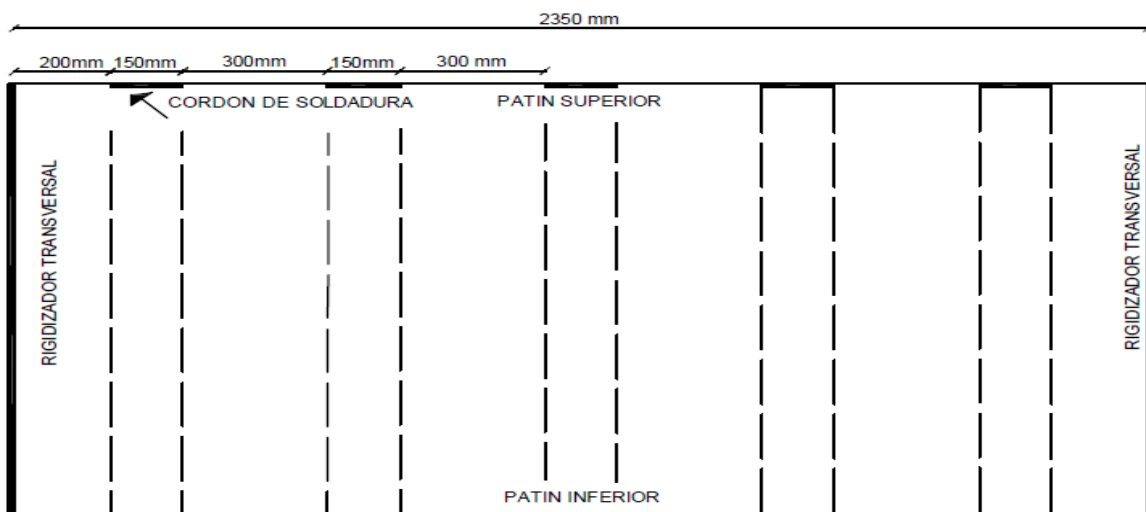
Vista lateral de cordón de soldadura del alma con el patín superior e inferior. Elaborado por: Autor
